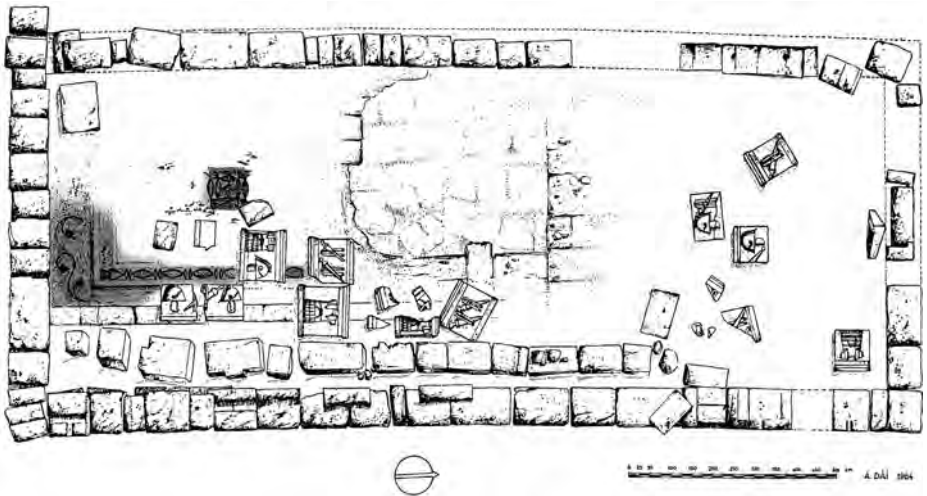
Torhaus, Grundriss der Terrasse (grau: Reste des Mosaikbodens)
